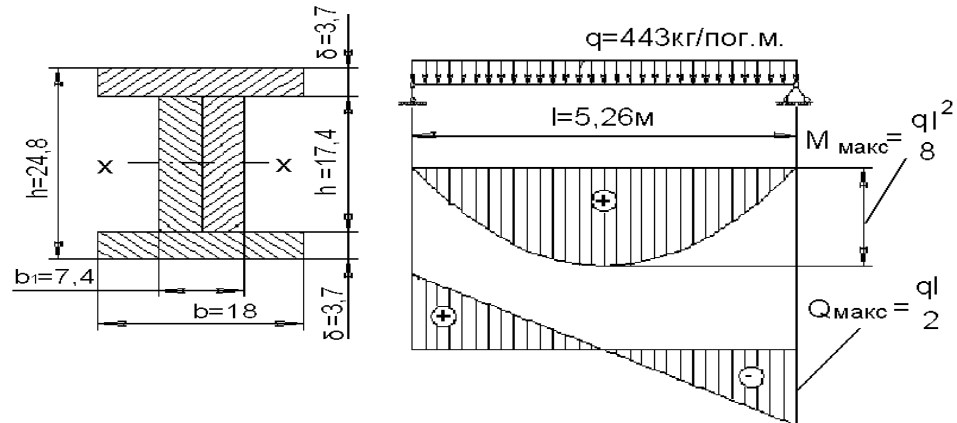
Расчетная схема двутавровой клееной деревянной балки
